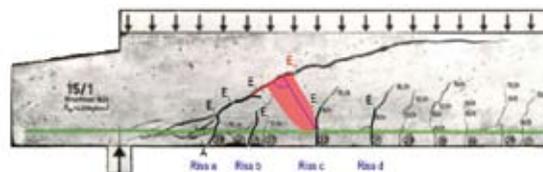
Ausschnittsvergrößerung des Balkens 15/1 aus [3] mit Kennzeichnung der Rissabschnitte A - E4a im Zustand II.4
